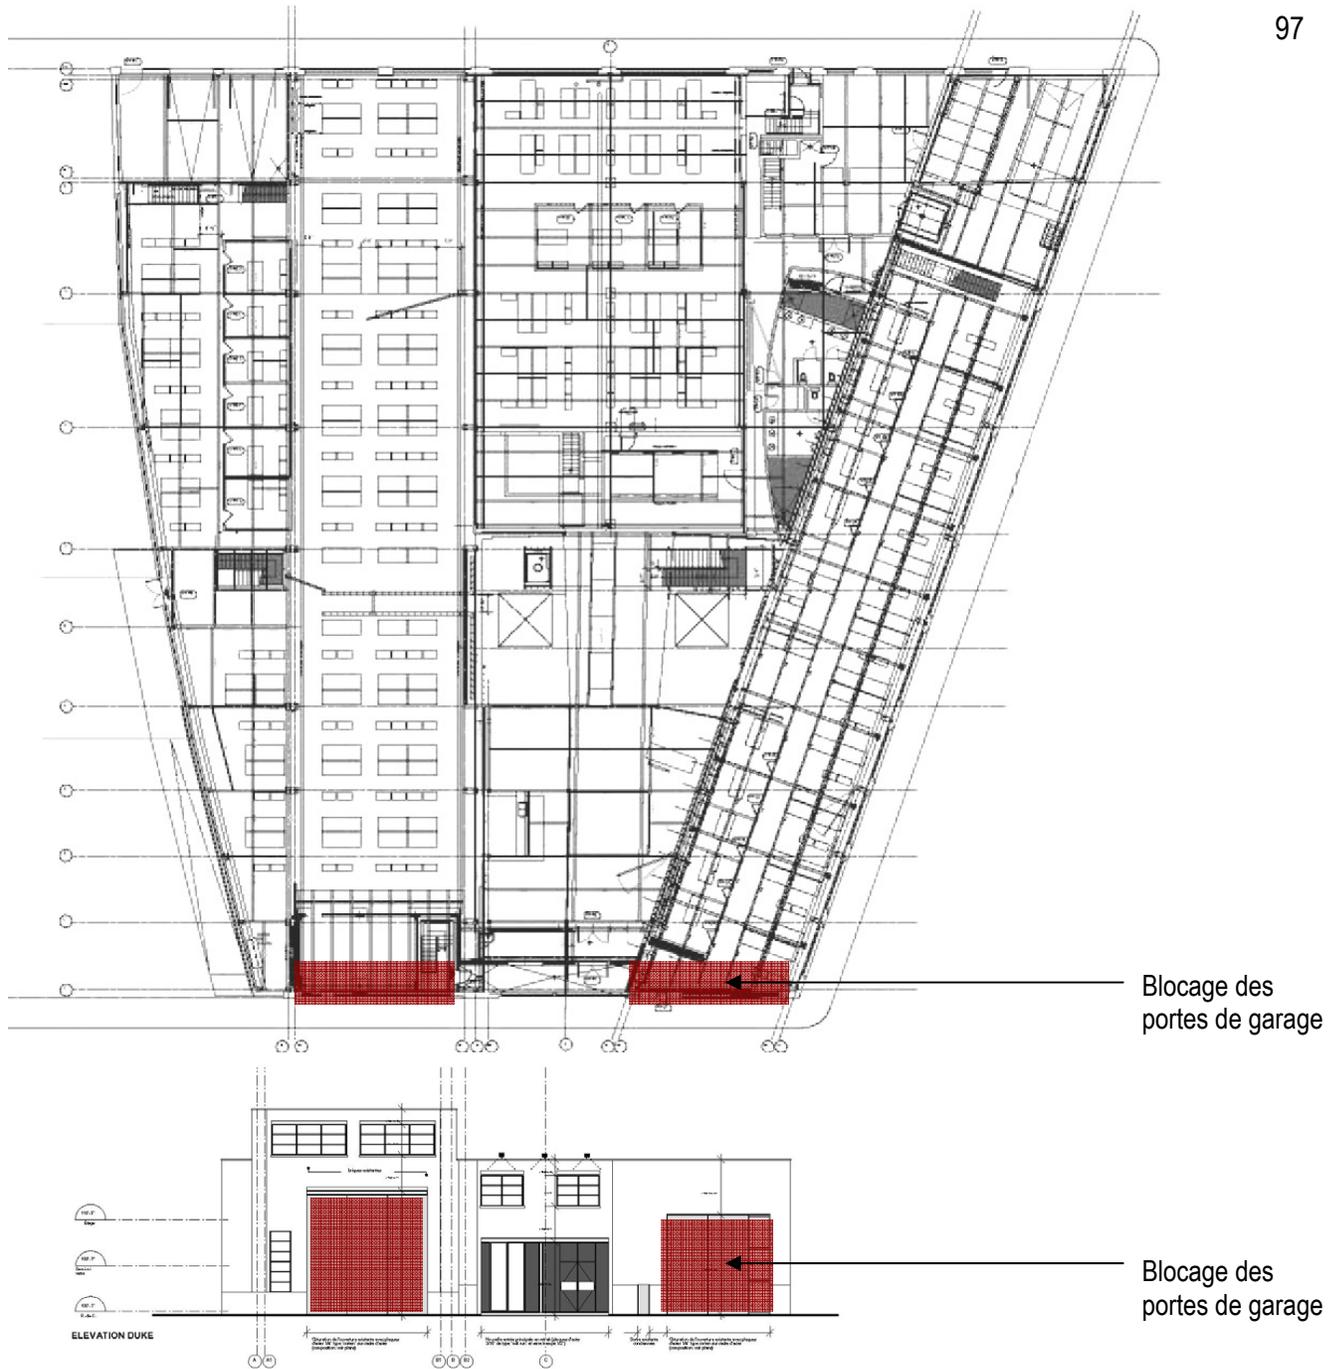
(A) Situation en plan et (B) en élévation du détail étudié<sup>58</sup>
